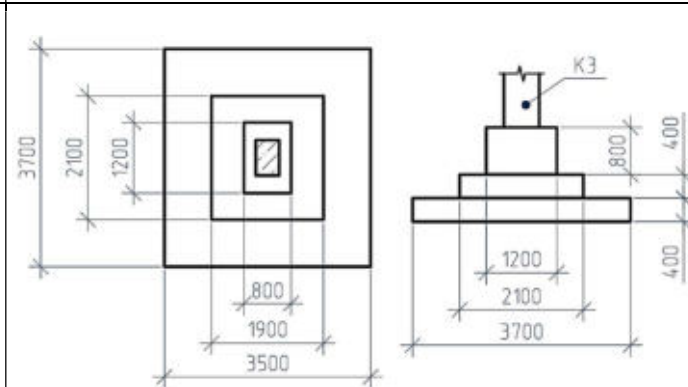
Общий вид конструкции фундамента в/о 22/А
